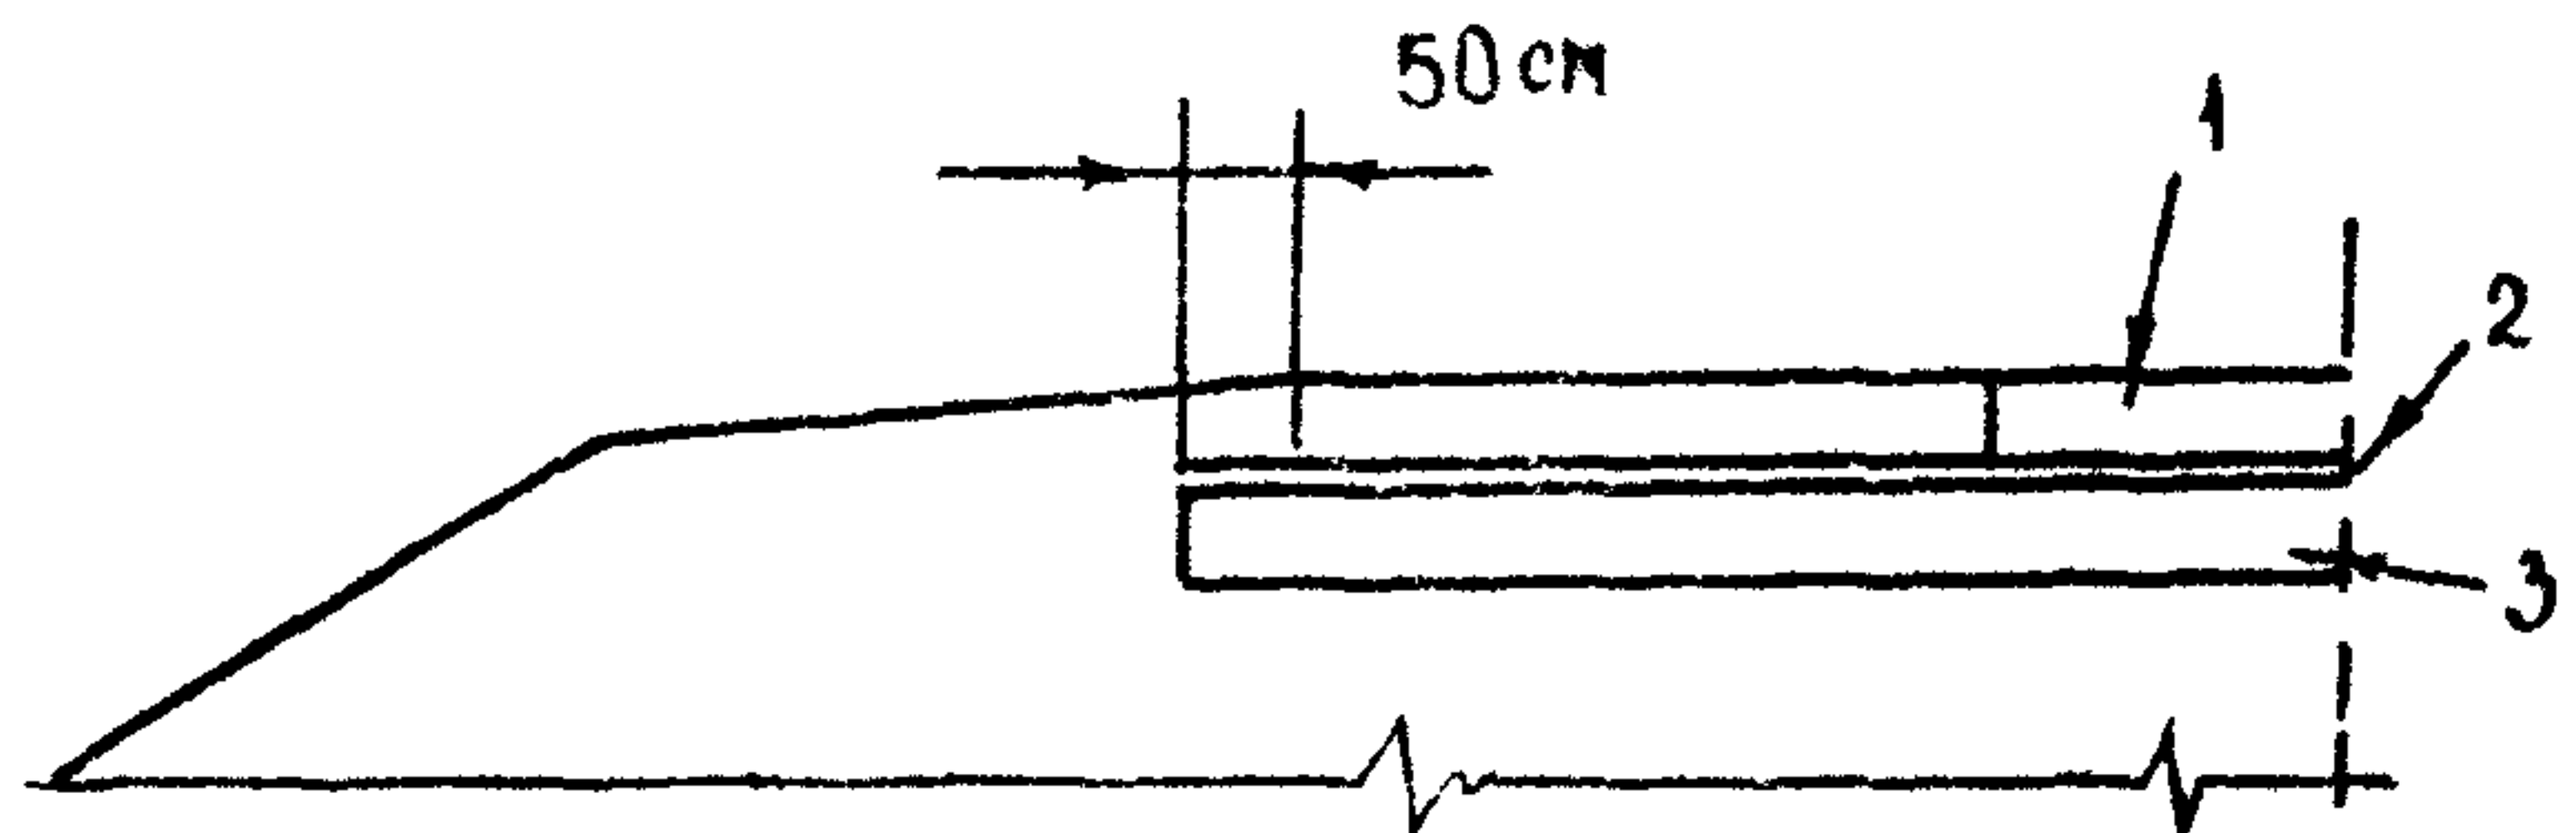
Сборное покрытие на цементогрунтовом основании:
